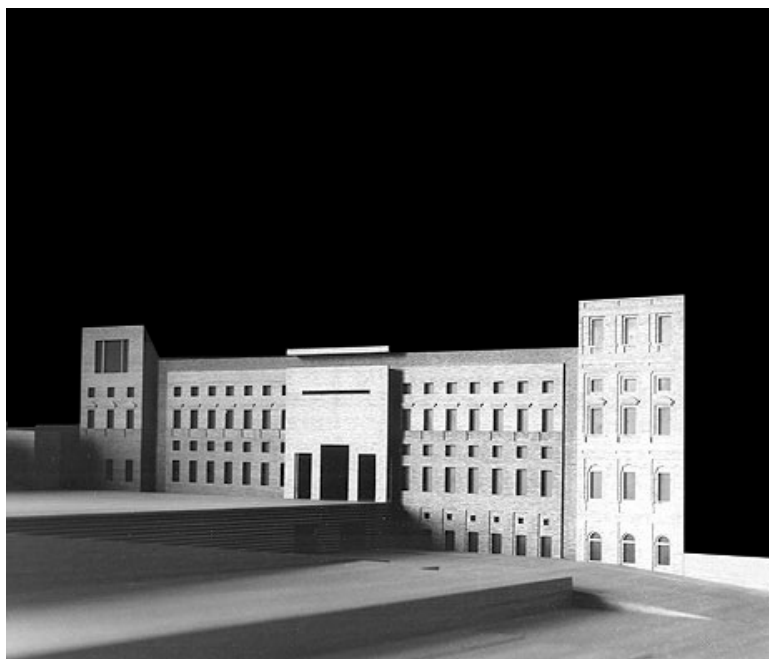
Plano de pormenor da Ajuda, Lisboa. Maqueta - 1990 1/500.
